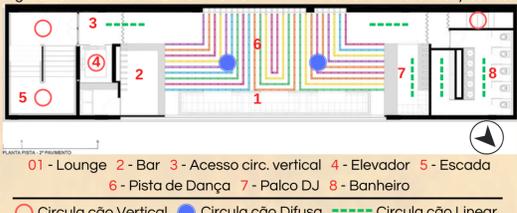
Planta Baixa 2º Pavimento Fonte: www.archdaily.com.br
